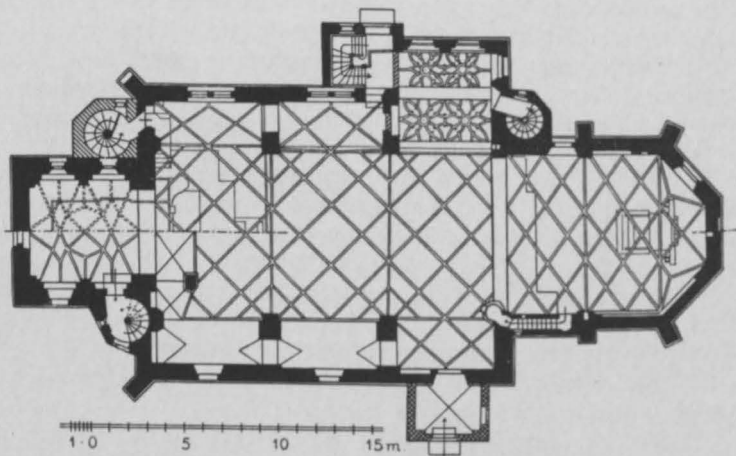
Zinsterwalde. Grundriß der Kirche.
